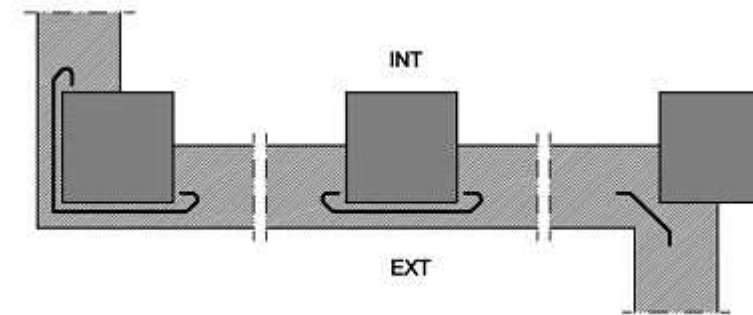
Ejemplo de encuentro de la fachada con los pilares
